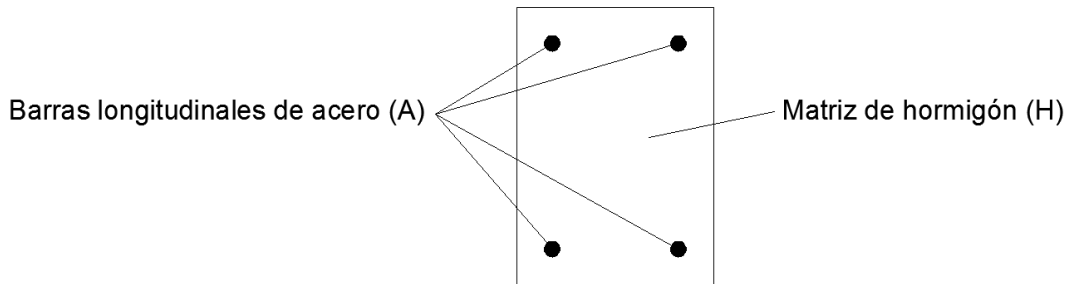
Esquema de la sección de la barra de hormigón armado sin cercos
